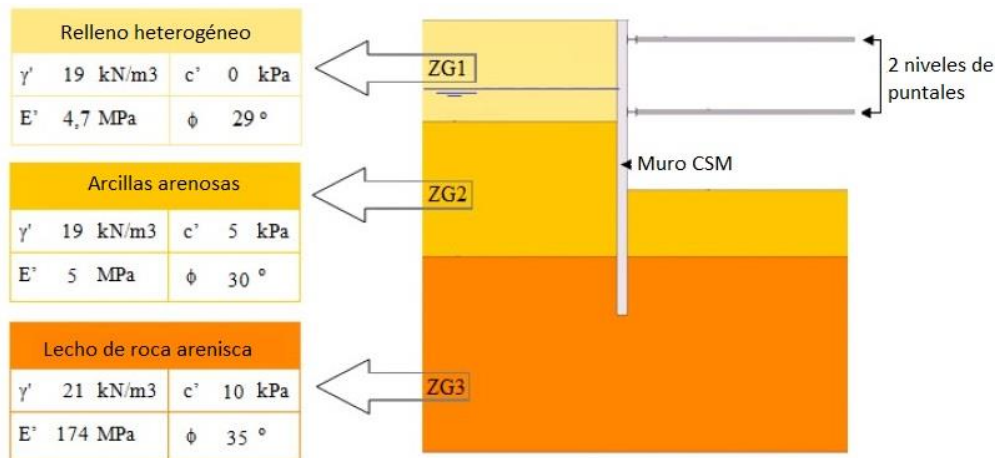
Parámetros geotécnicos y representación de una sección de la excavación. Fuente: Peixoto et al. (2012).
